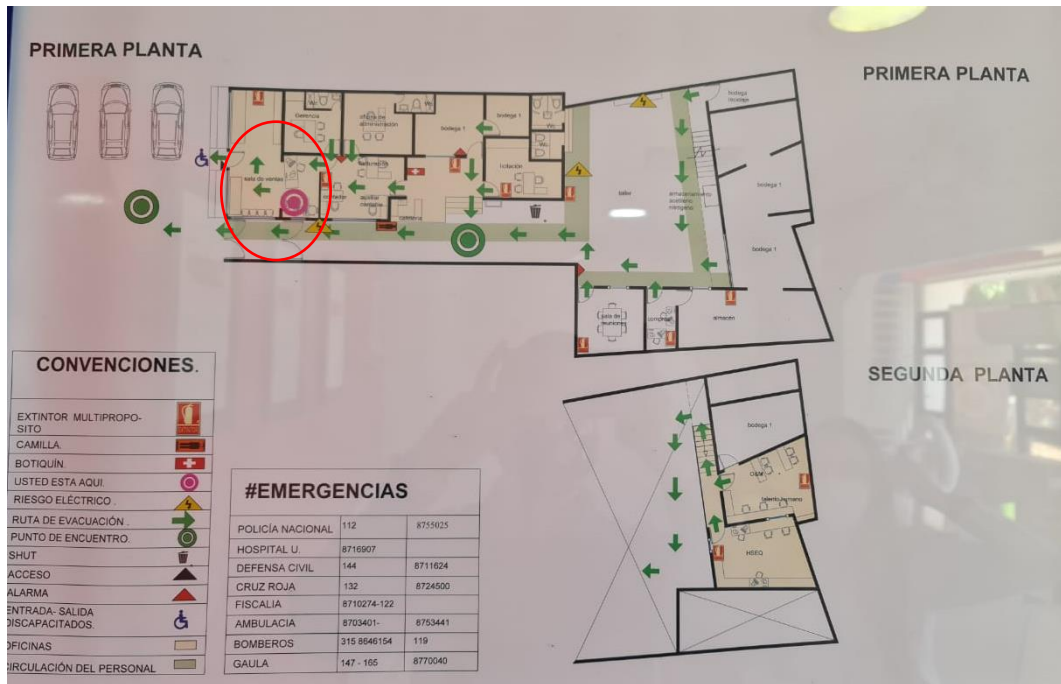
Plano de layout de la empresa Freez Ingenierías sas
